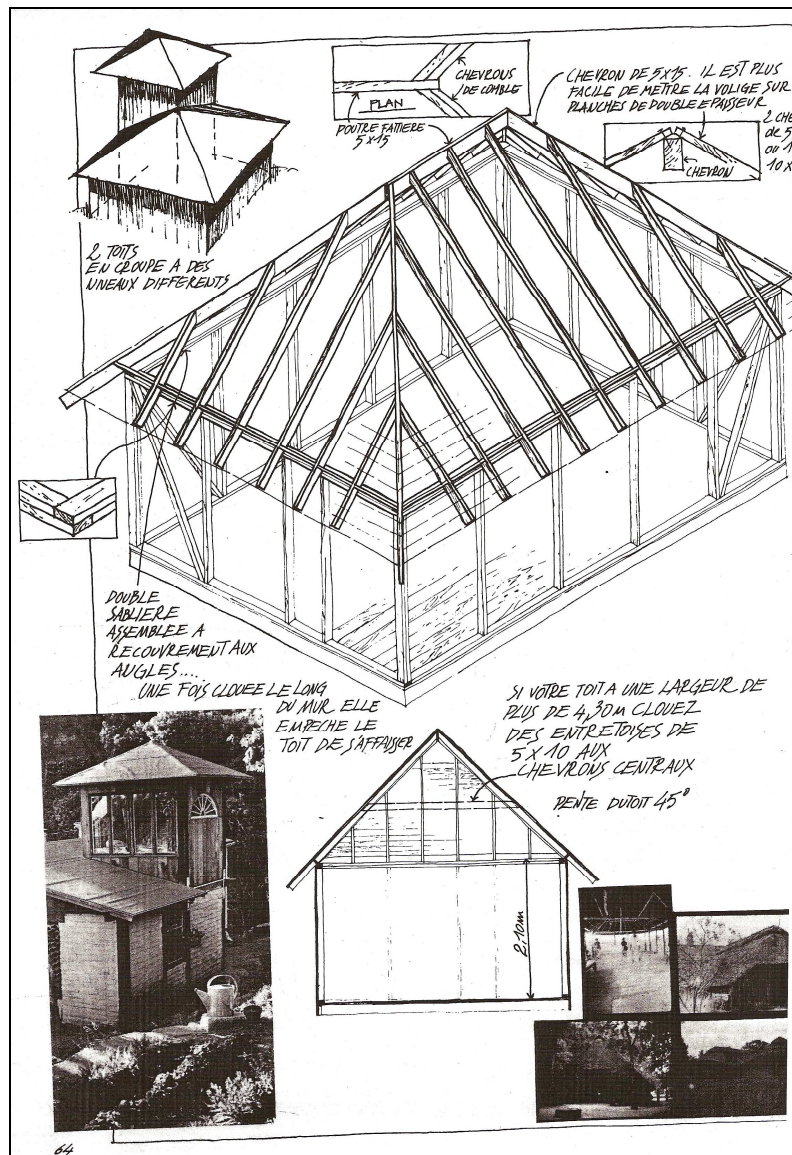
GAC Pierre, Shelter, Habitats : constructions traditionnelles et marginales, Paris, éditions Alternative et parallèles, 1977. Page 64.
